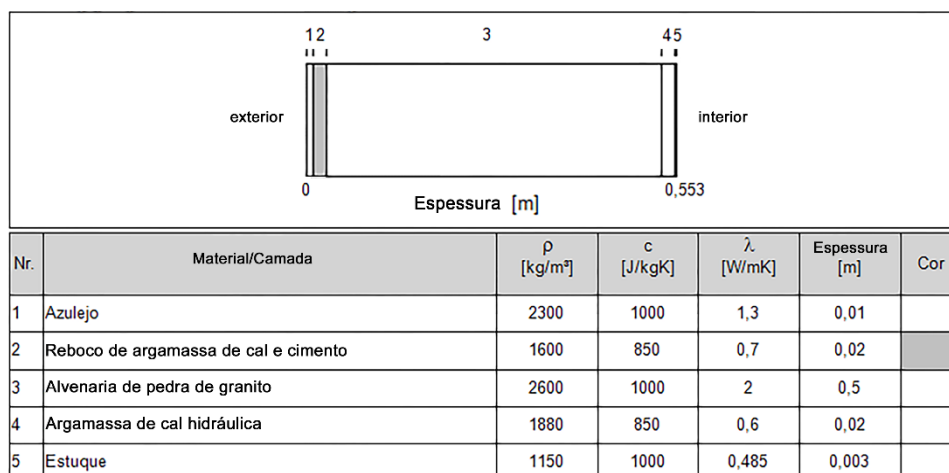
Pormenor construtivo da parede exterior de fachada em estudo
